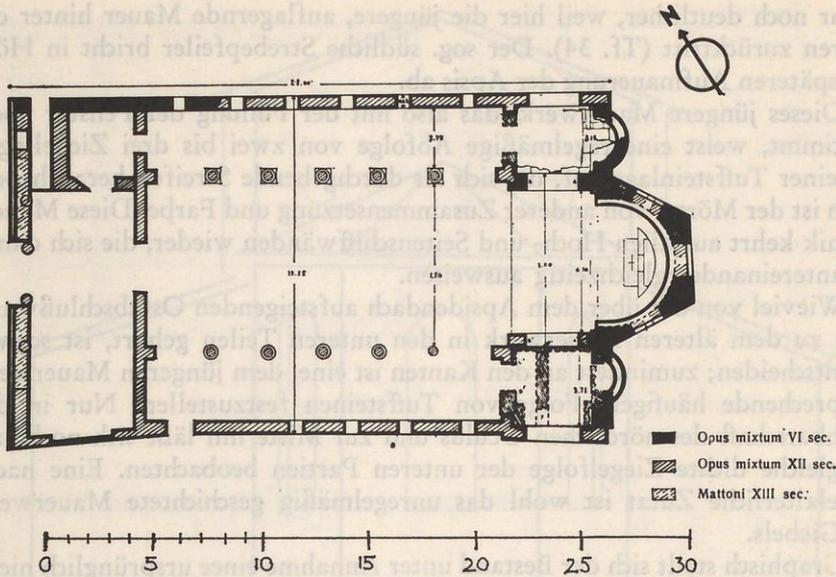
S. Giovanni a Porta Latina, Grundriß nach Krautheimer
